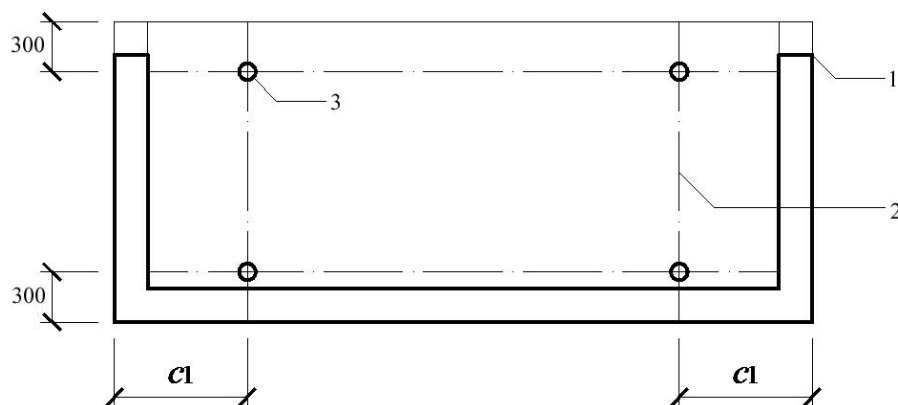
全预制阳台临时支撑架立杆平面布置示意
